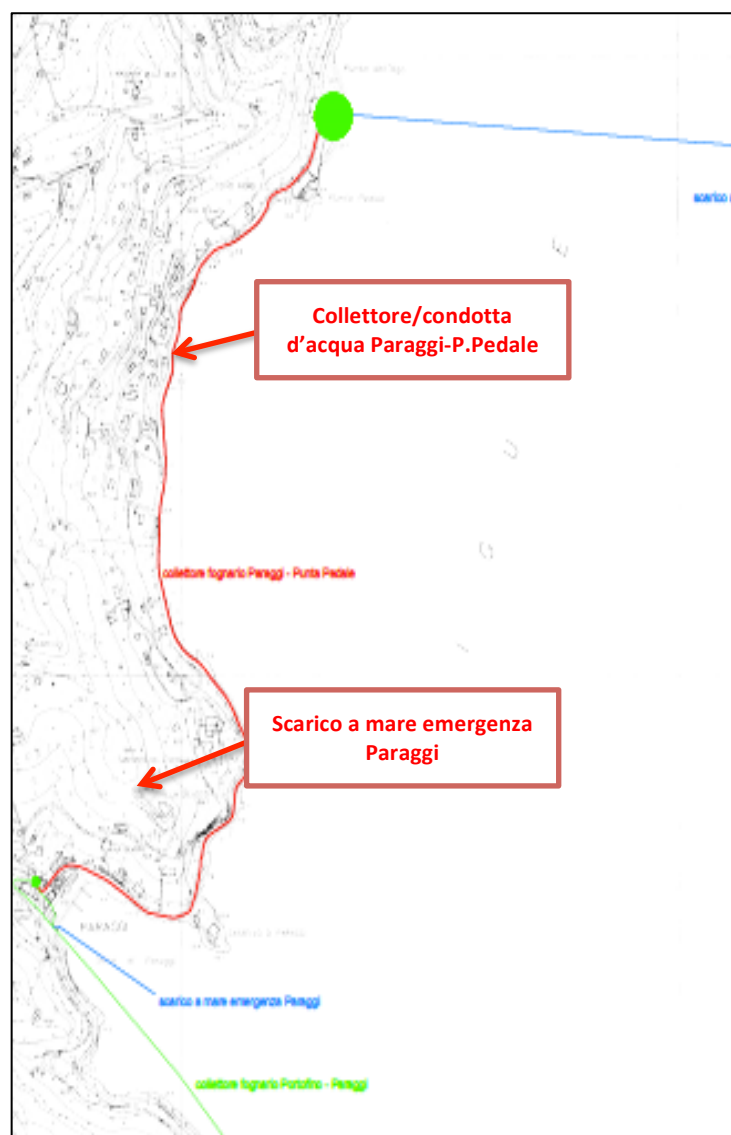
Planimetria generale degli interventi in progetto (da committenza)
